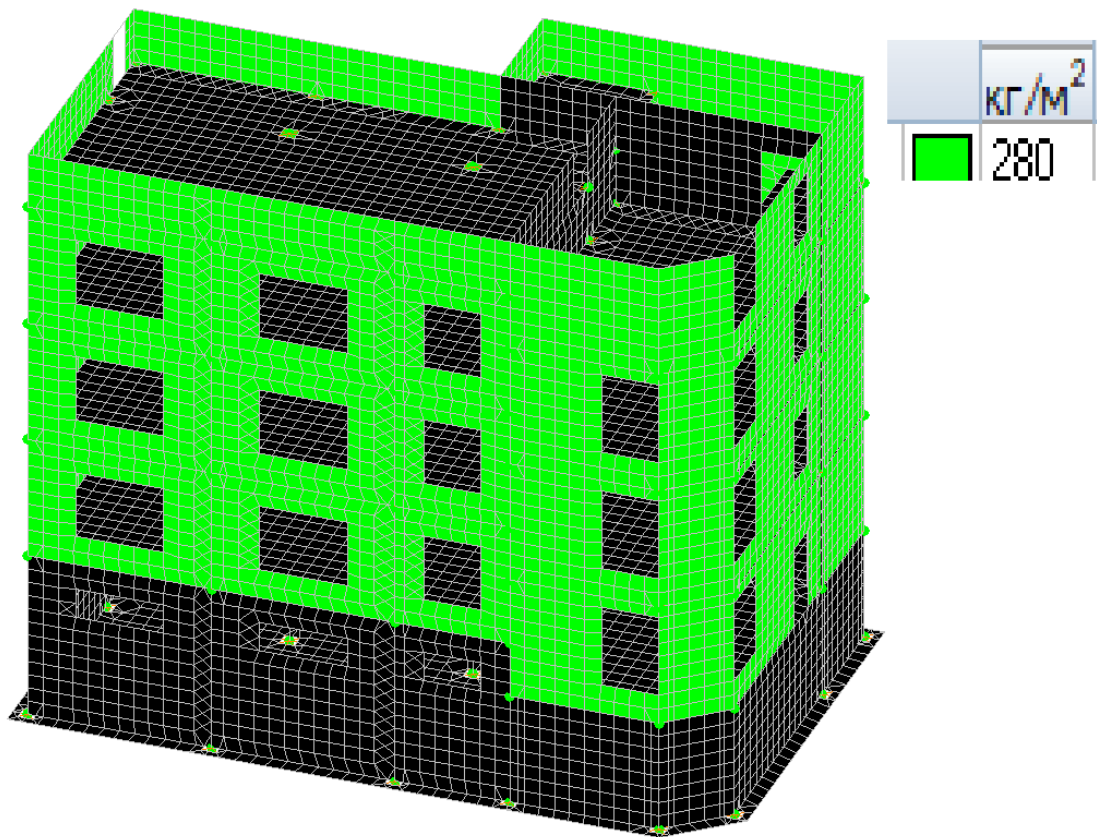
Схема приложения нагрузок от веса стен
